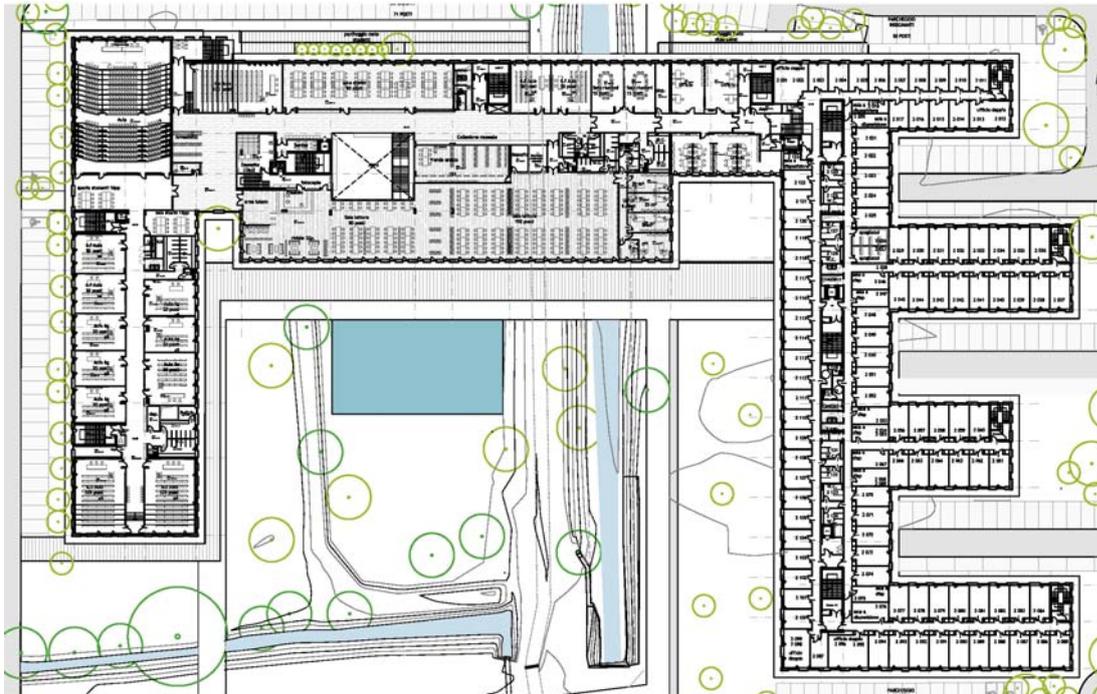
Pianta piano secondo Lotto 1-2 e identificazione funzionale
